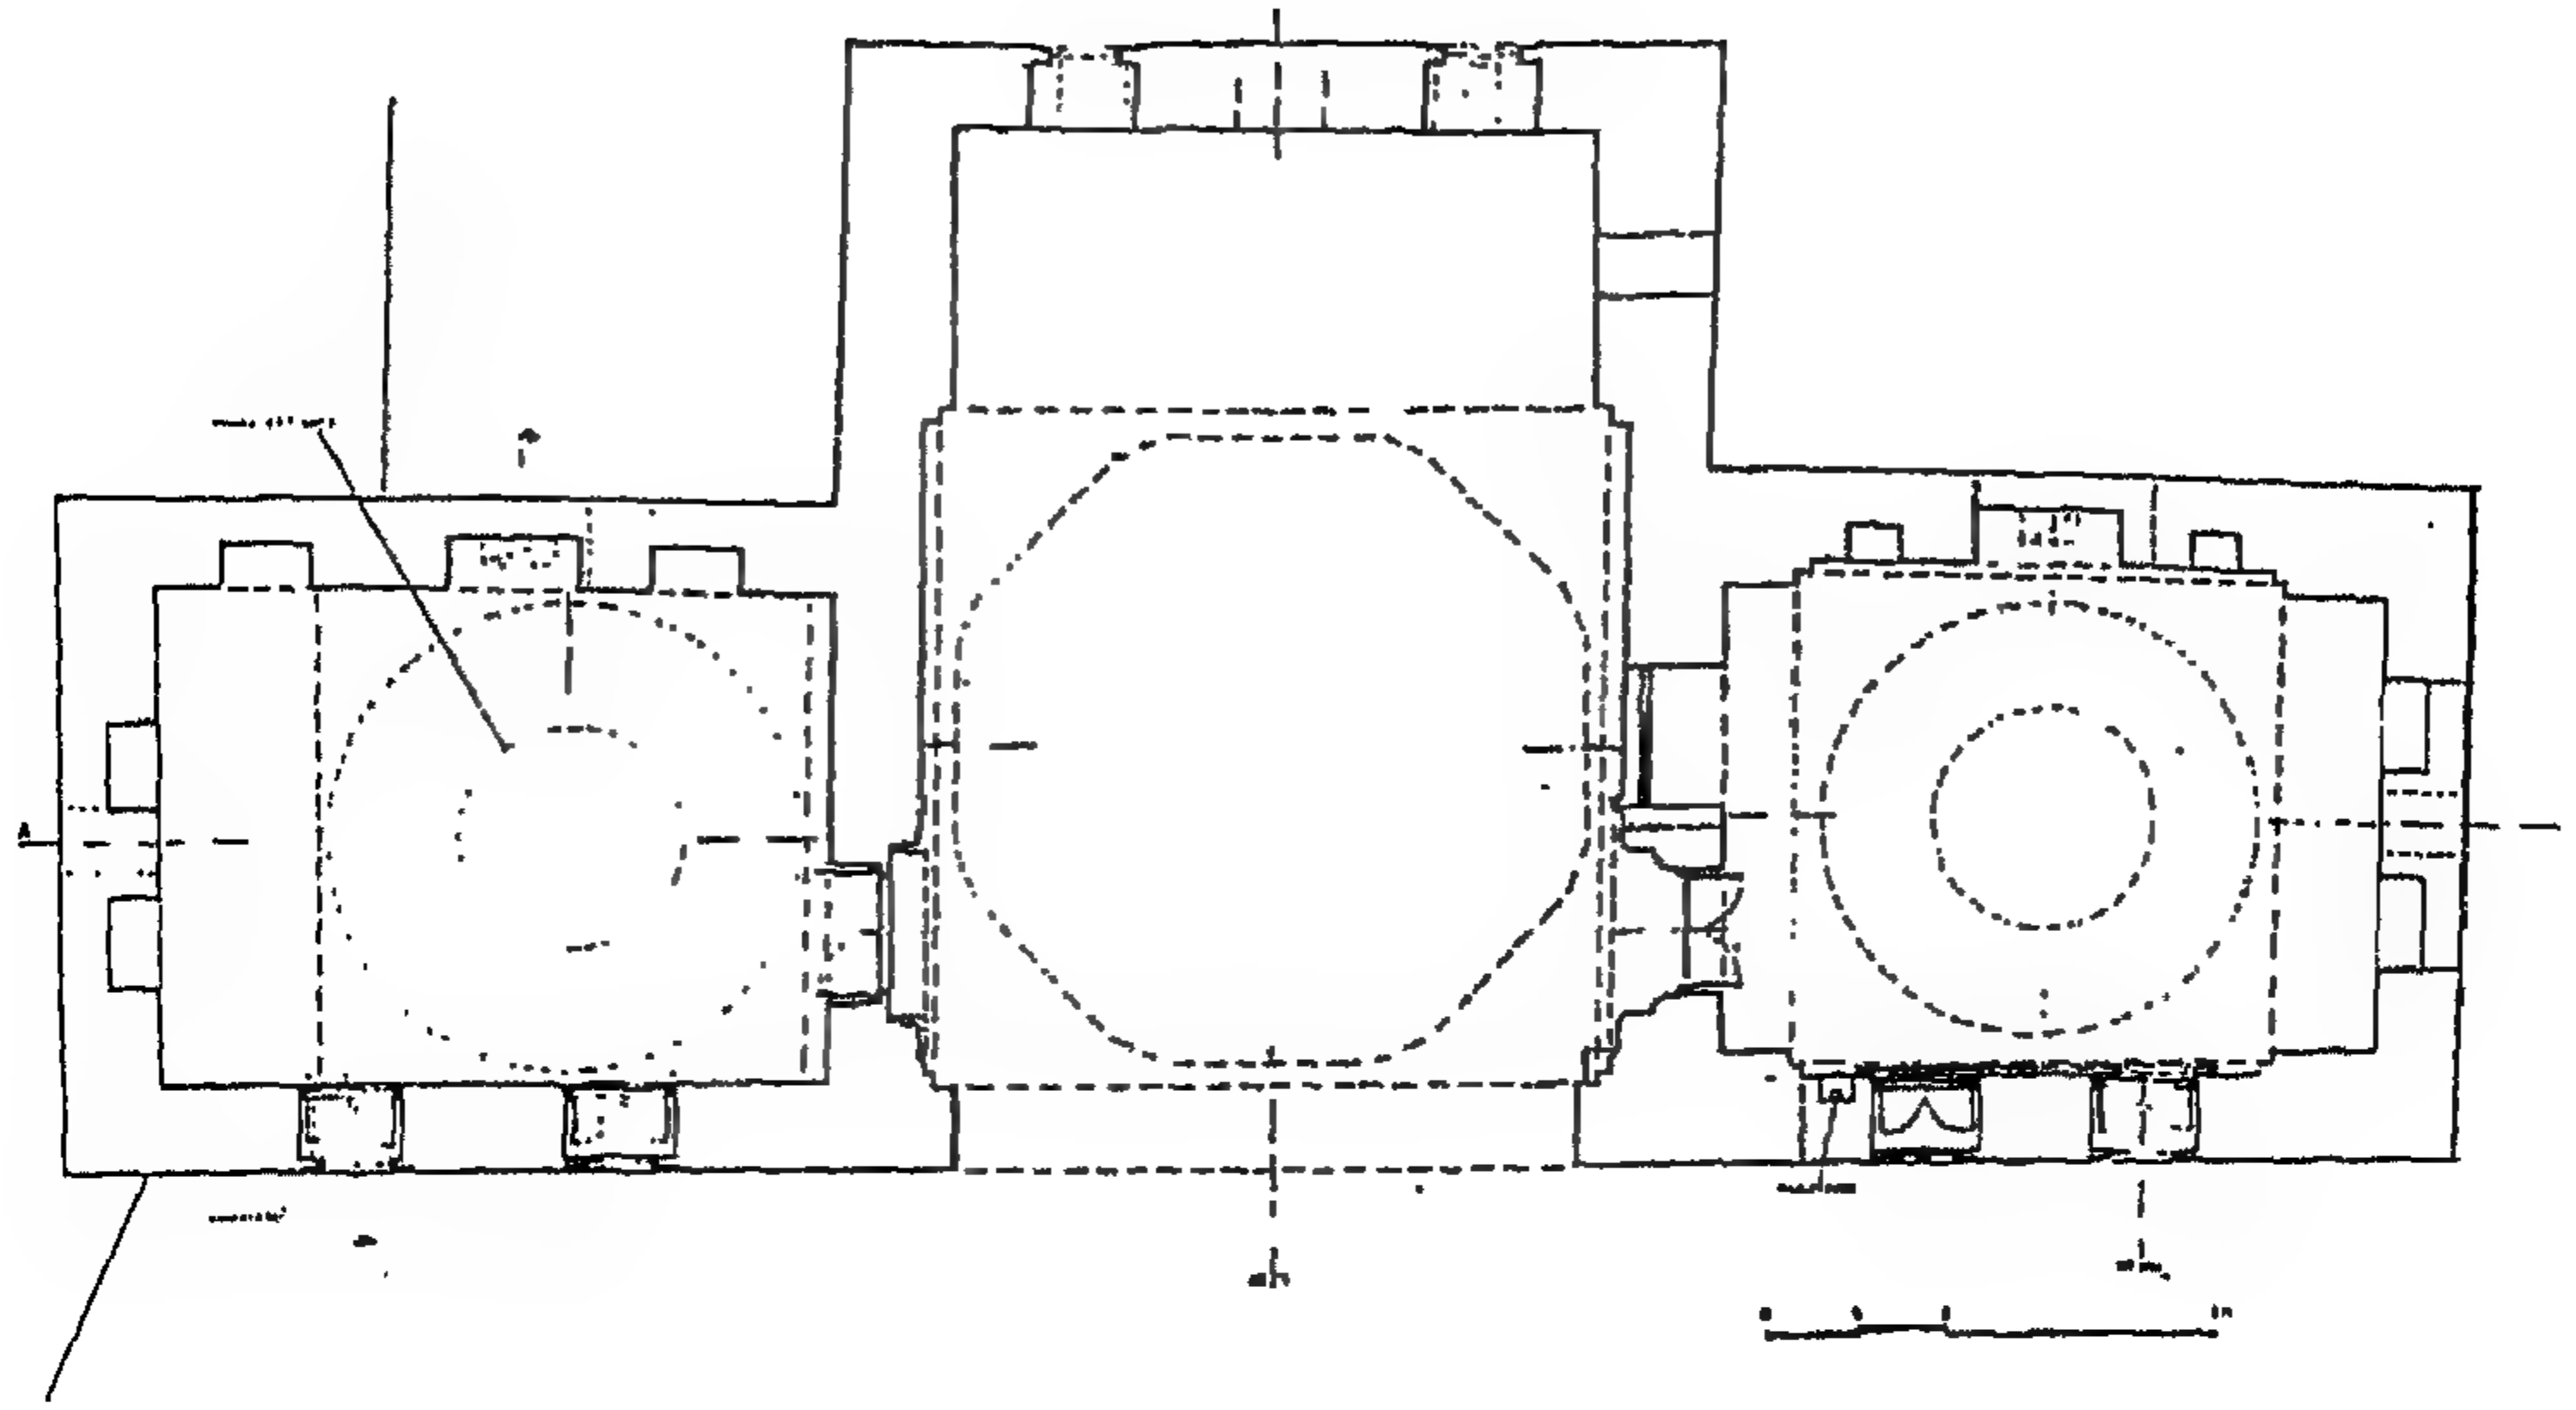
مسقط أفقي لجامع اسحاق باشا في إينه كول . (عن : Kuran).
